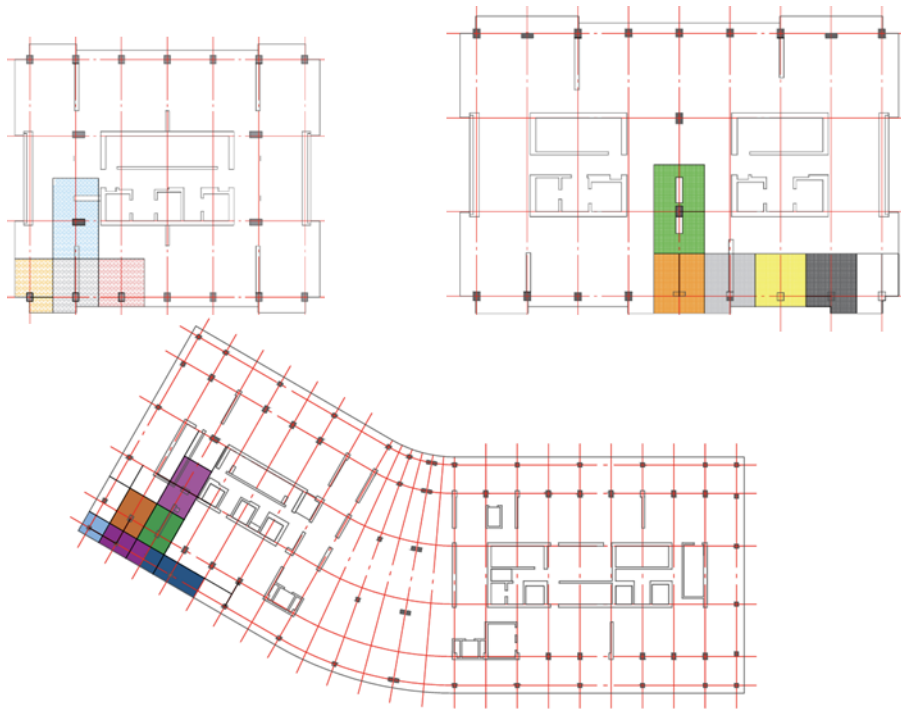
vue en plan qui représente la surface chargée revient aux poteaux
